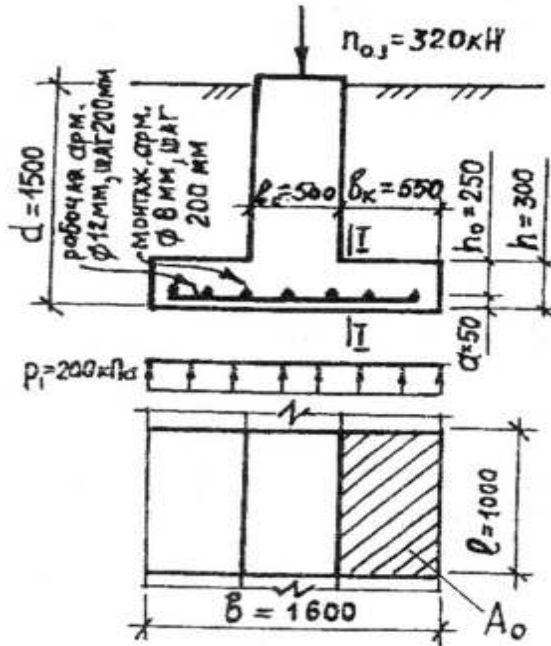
Схема для определения арматуры в фундаментной плите
